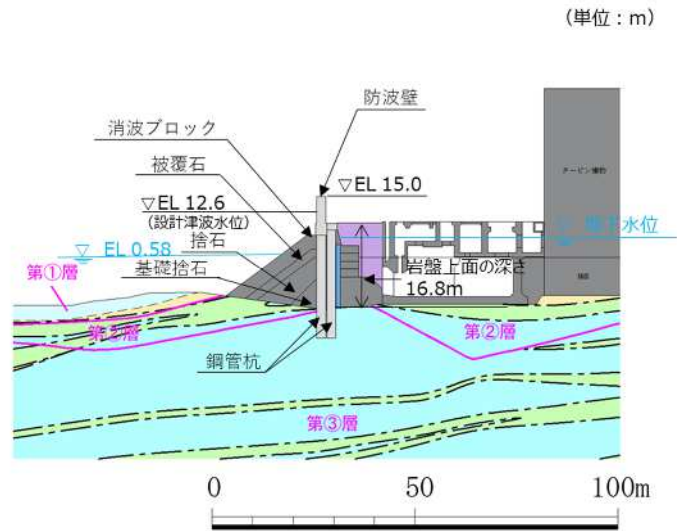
防波壁（多重鋼管杭式擁壁）の横断面図
